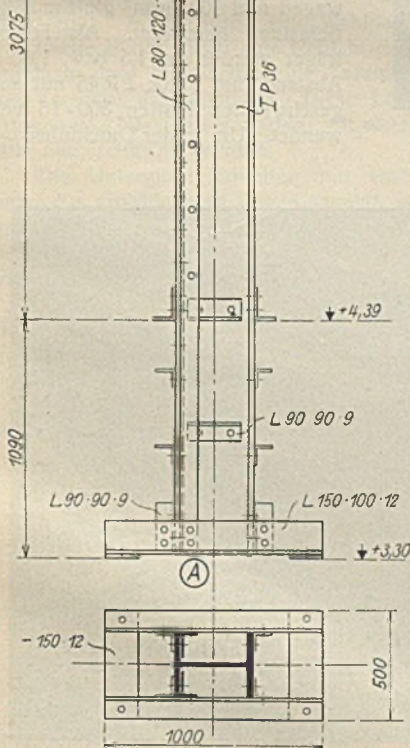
Automobilhalle mit geschweißter Stahlkonstruktion.
